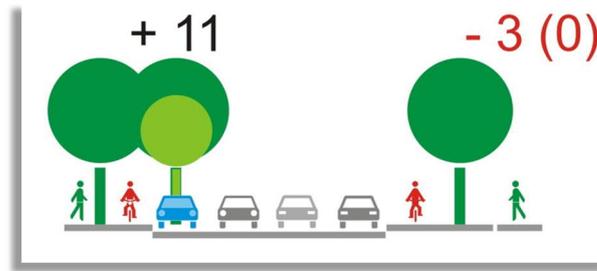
Abschnitt A – Baumbilanz (Klammervert: mit Grunderwerb)
